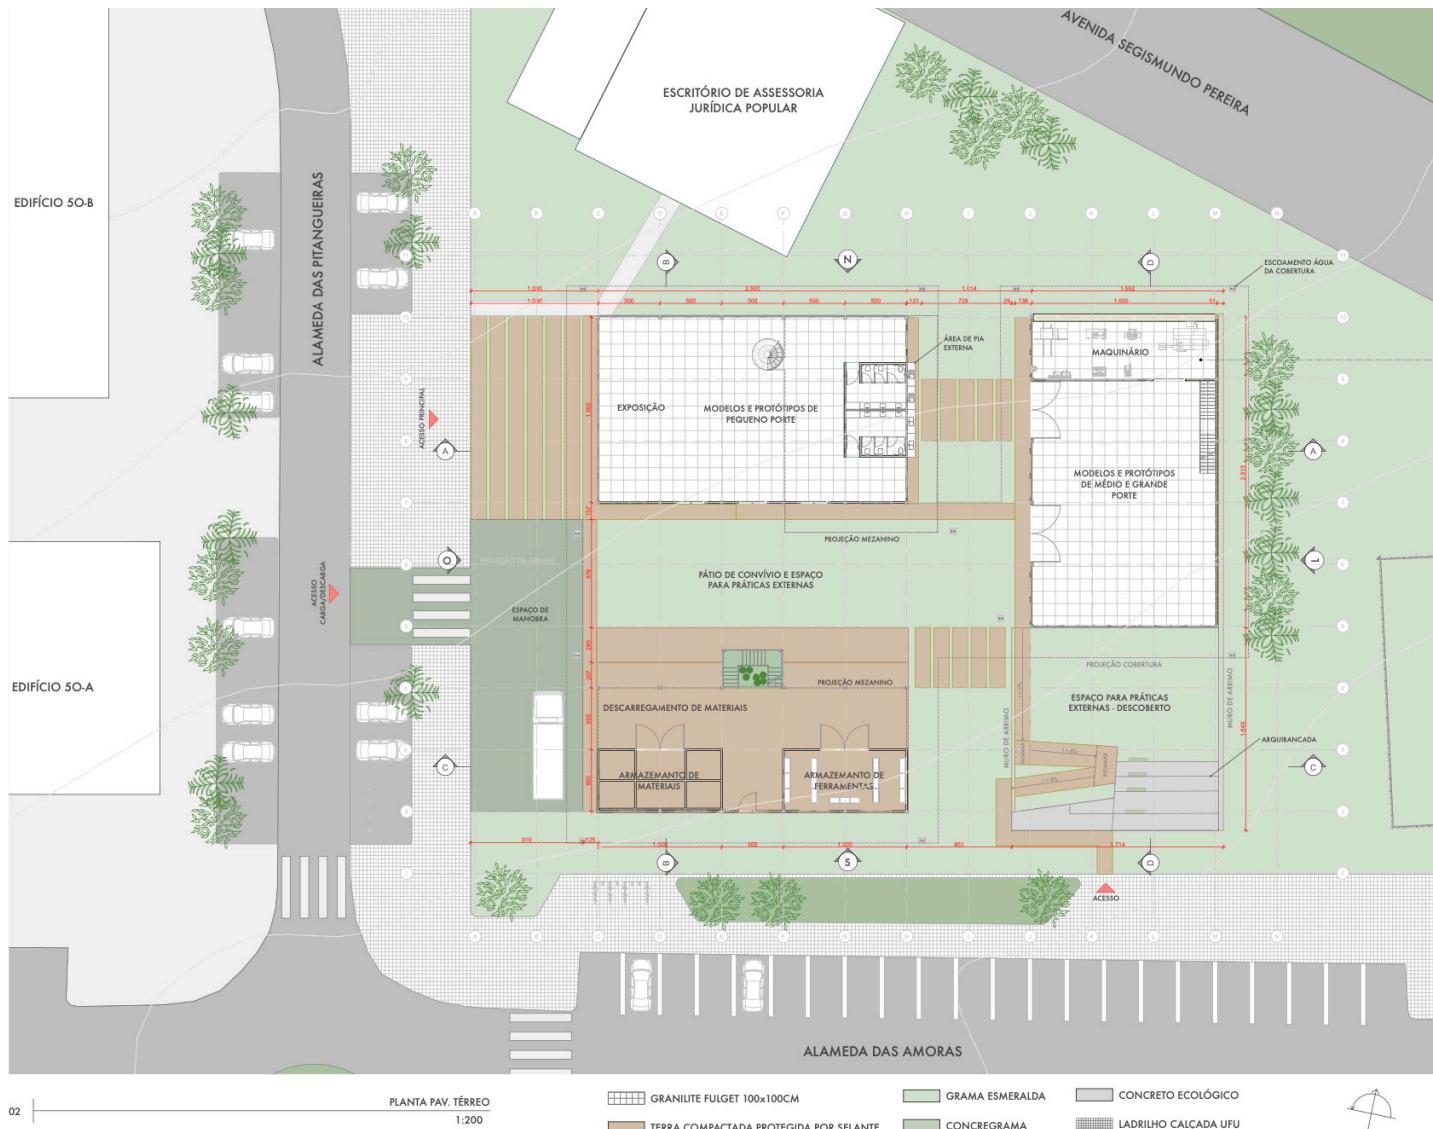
Planta do pavimento térreo. Fonte: Autora.
